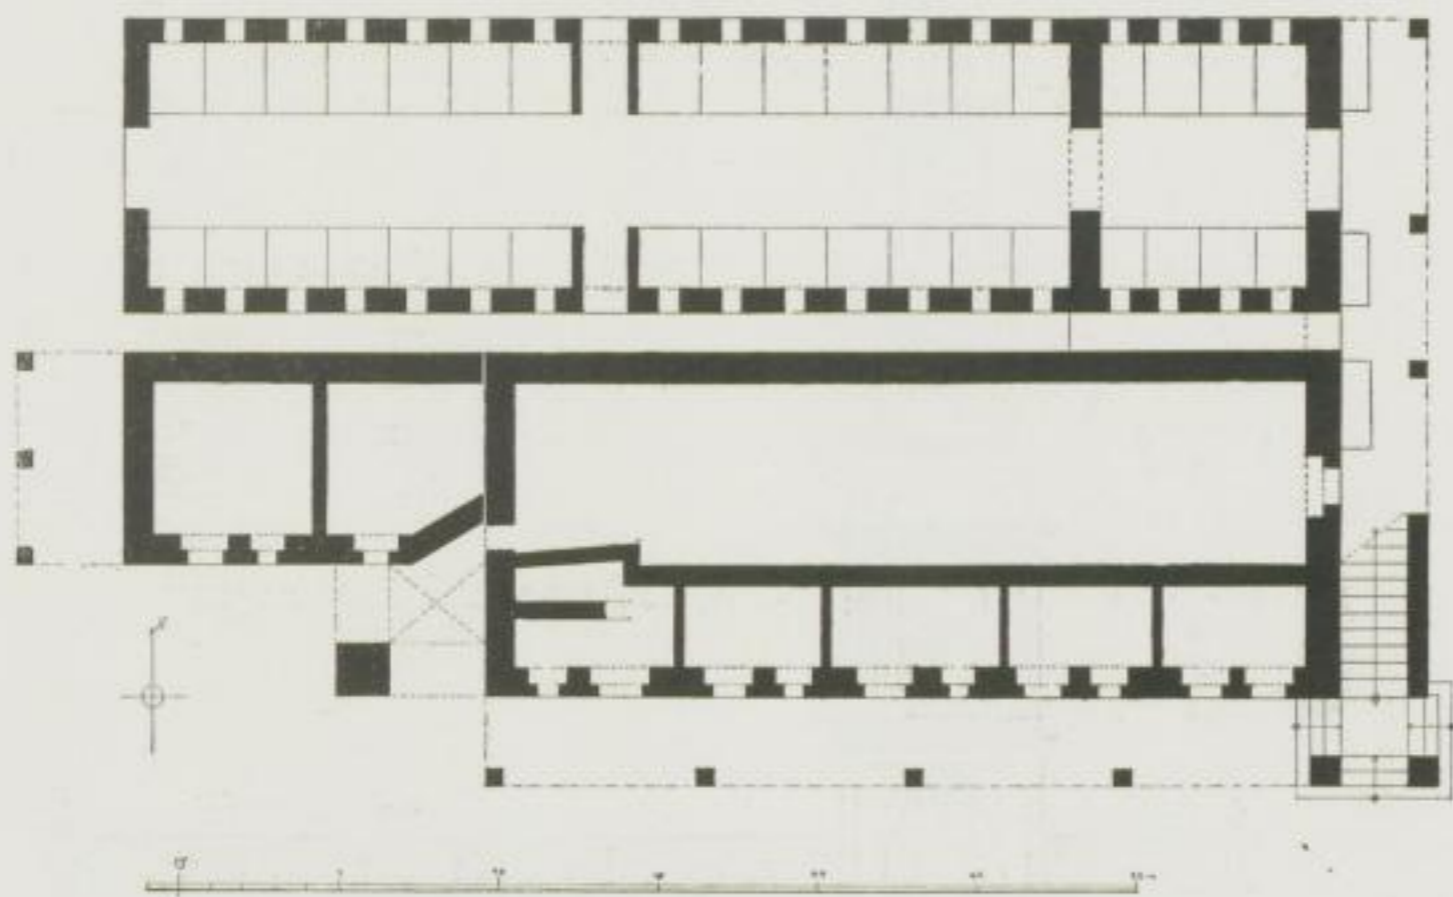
Erdgeschoßgrundriß des alten Rathauses um die Mitte des 18. Jahrhunderts
